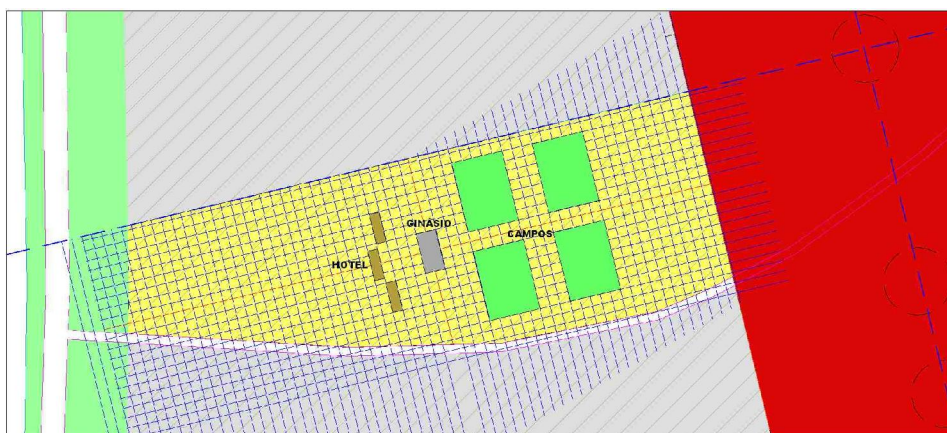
Primeiro estudo de lote e implantação. Fonte: AUTOR
